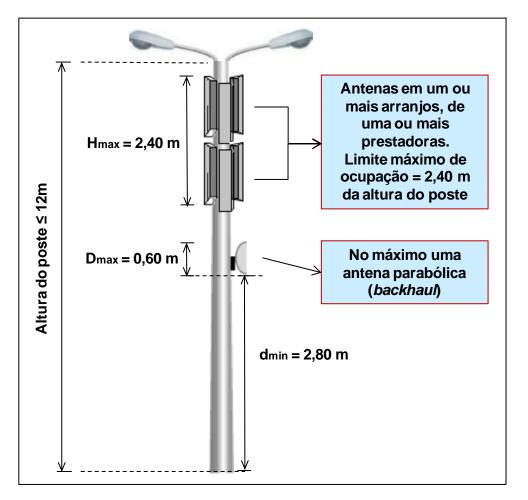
Instalação em poste com menos de 12 m em outras áreas urbanas
